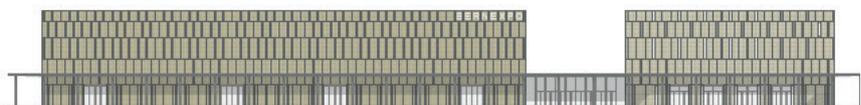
Westfassade (Quelle: Richtprojekt, 24. August 2018)
